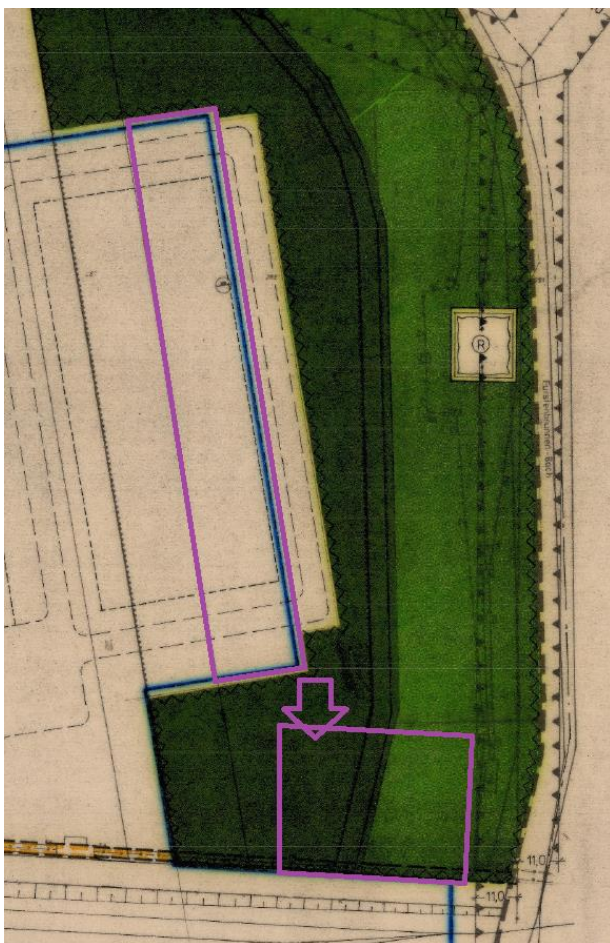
Geplante Änderung der Flächen des Bplanes (Bebaubare Fläche zu Grünflächen, Grünflächen zu bebaubarer Fläche)
